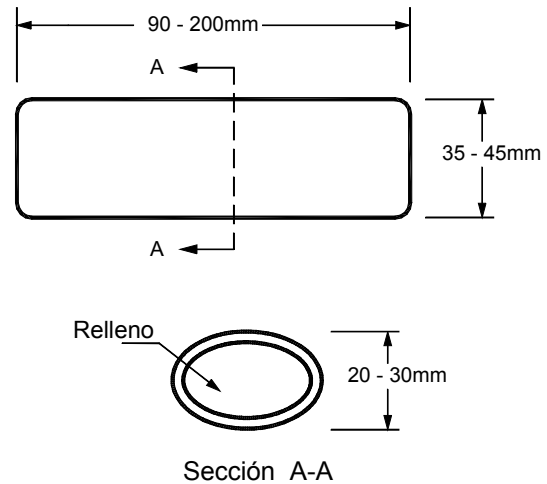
Bolsa de geotextil rellena de concreto (bolsacreto).
